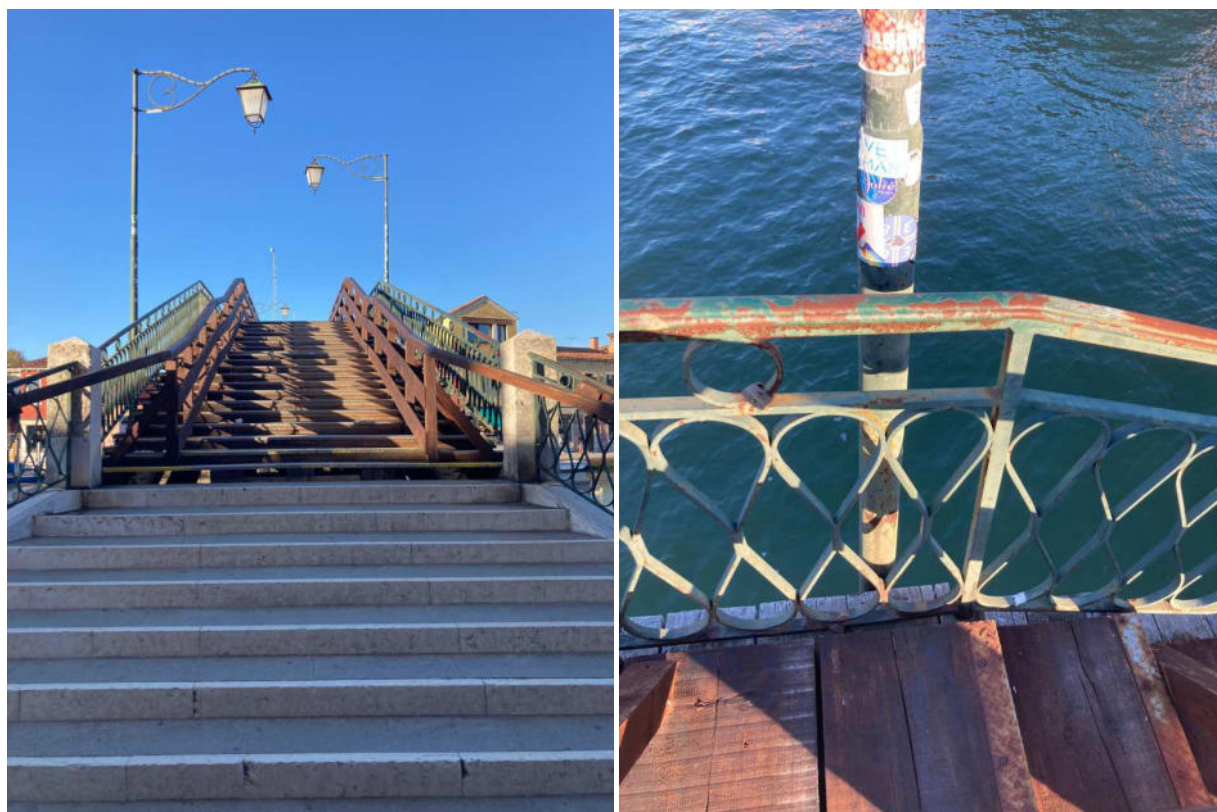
Parapetto e nuova pavimentazione per la messa in sicurezza temporanea
